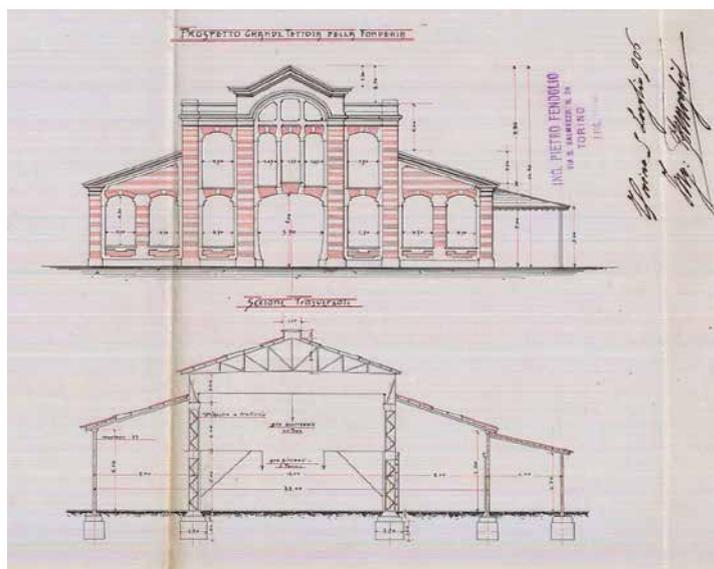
Prospetto e sezione trasversale della fonderia dello stabilimento Ballada.
